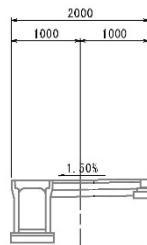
(11) 標準断面图 (特殊道路 幅員 2.0m)
